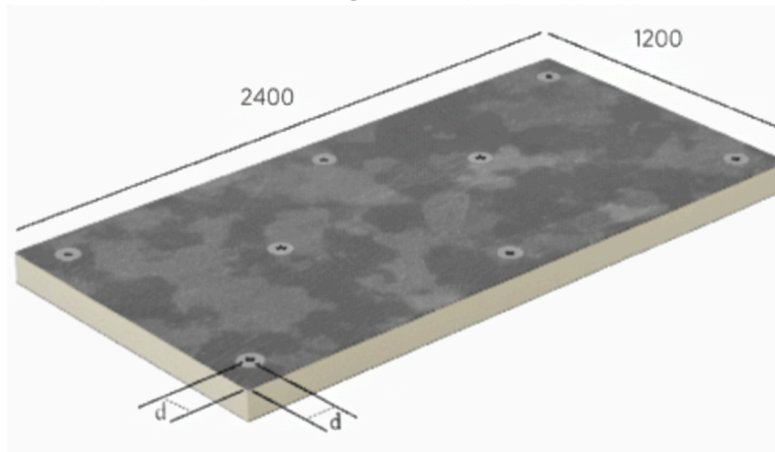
x 1200 mm: 2,7 fijaciones/m² (8 fijaciones/plancha) 100 ≤ d ≤ 250 mm
